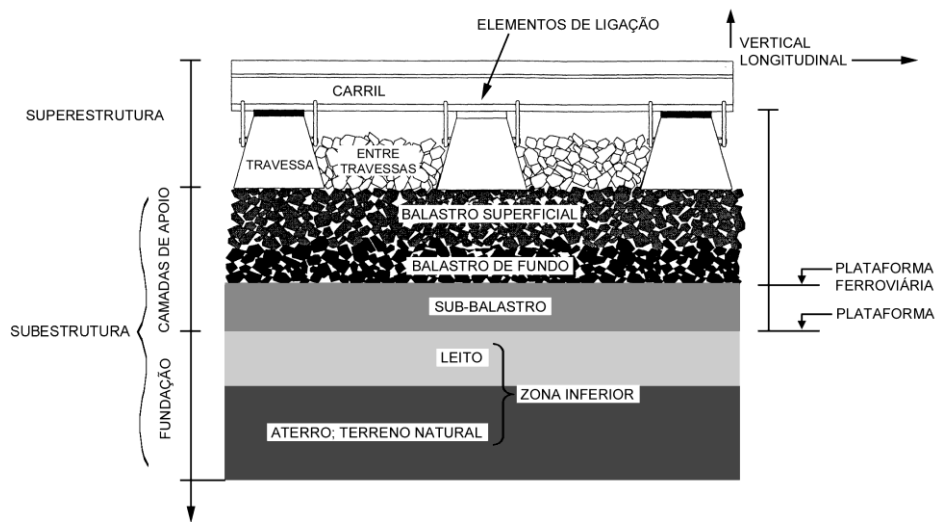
Esquema estrutural da via balastrada em perfil longitudinal (Fortunato, 2005)
